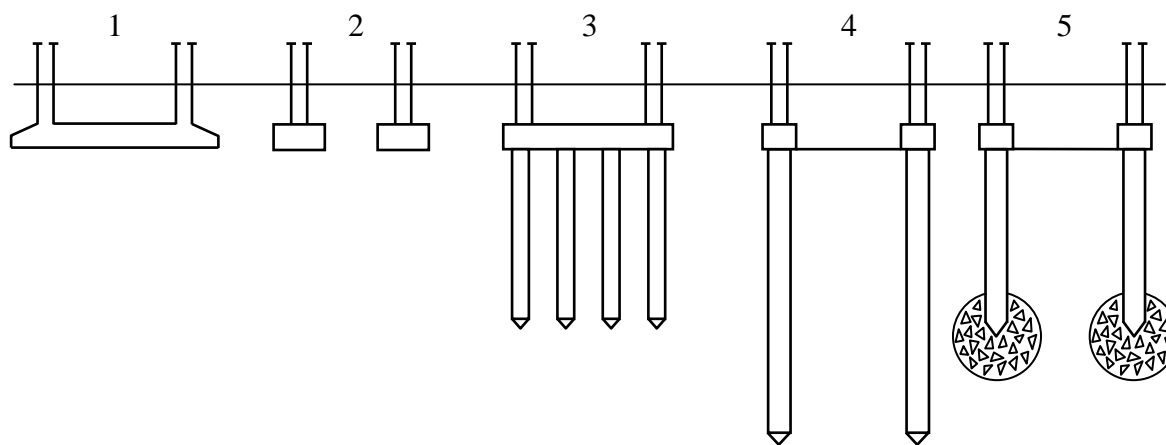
Окремі фундаменти під споруди баштового типу:
